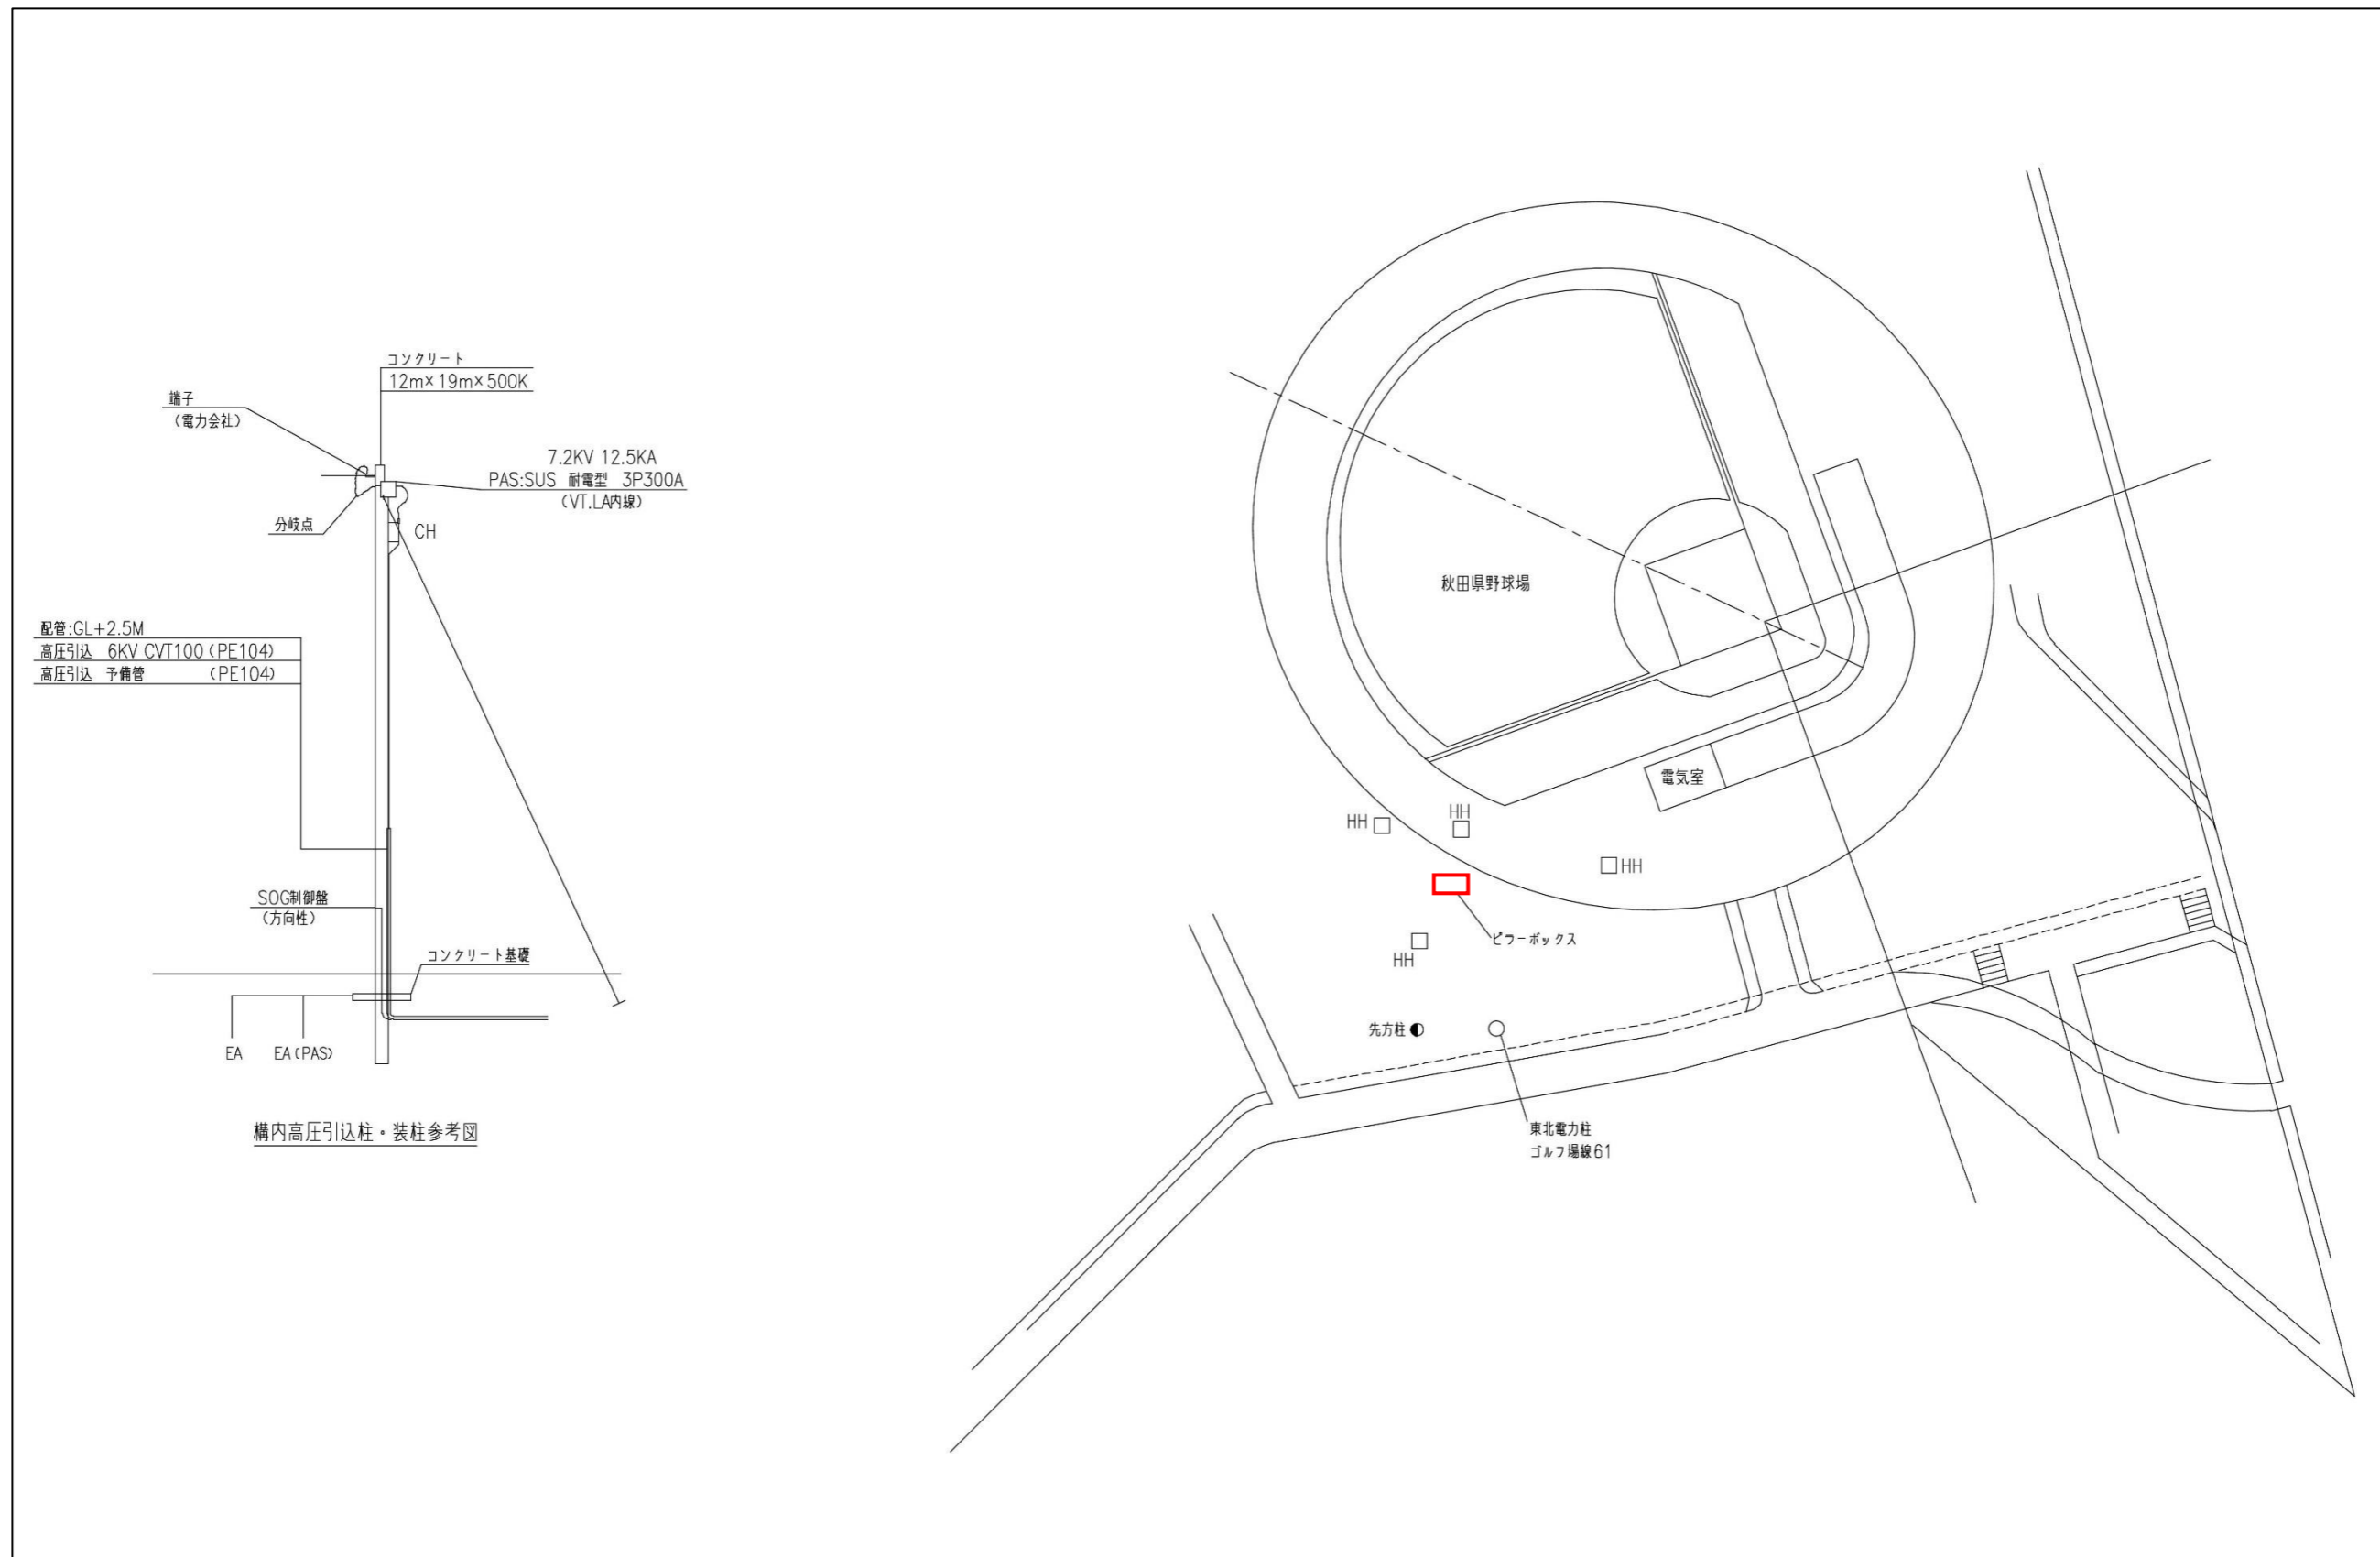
県立野球場平面図 (ピラーボックス設置位置案)
